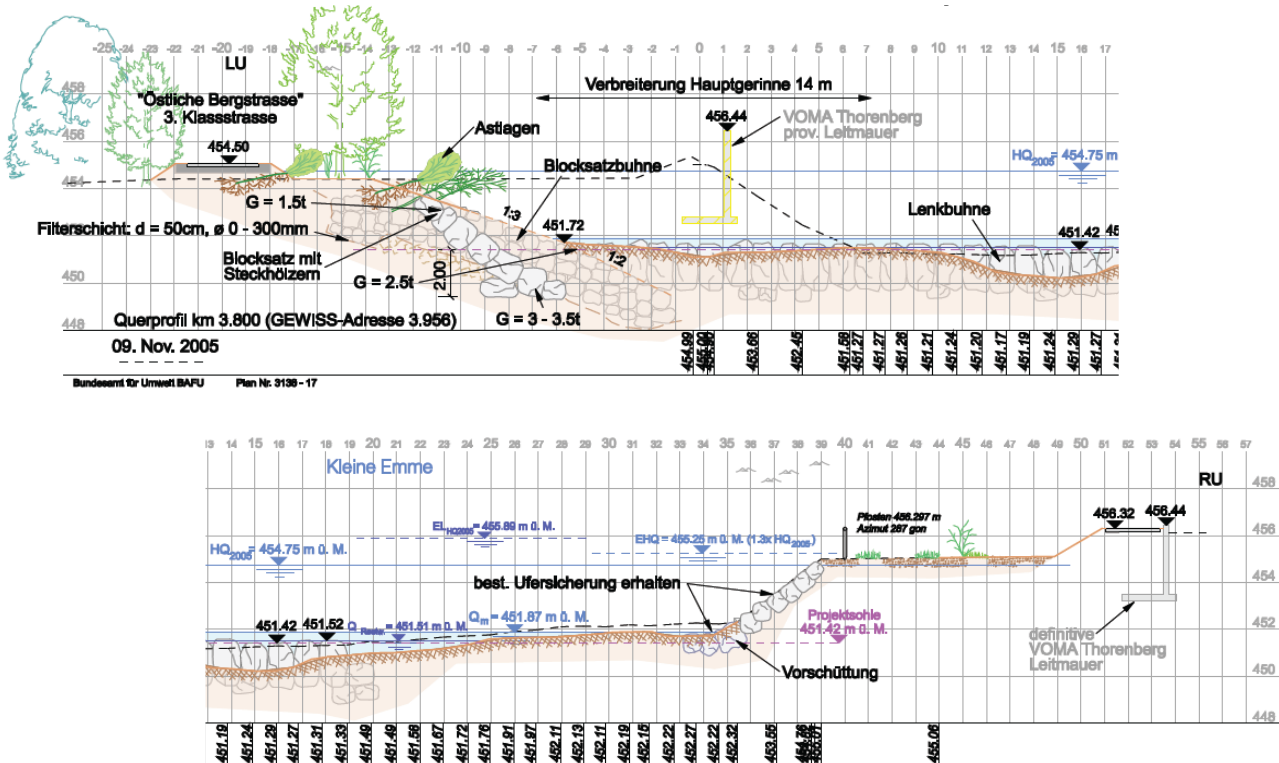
Plan de réaménagement de la Petite Emme, selon un projet de 2005 (en haut : rive gauche ; en bas : rive droite).
